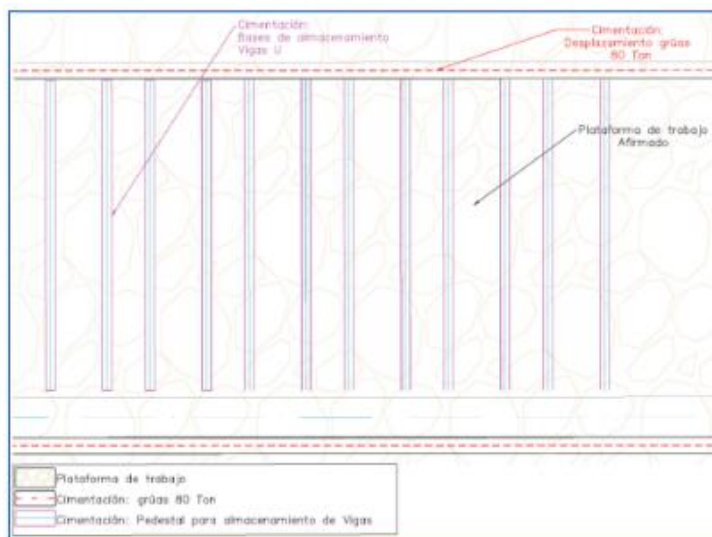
detalle de cimentaciones almacenamiento de vigas U.
